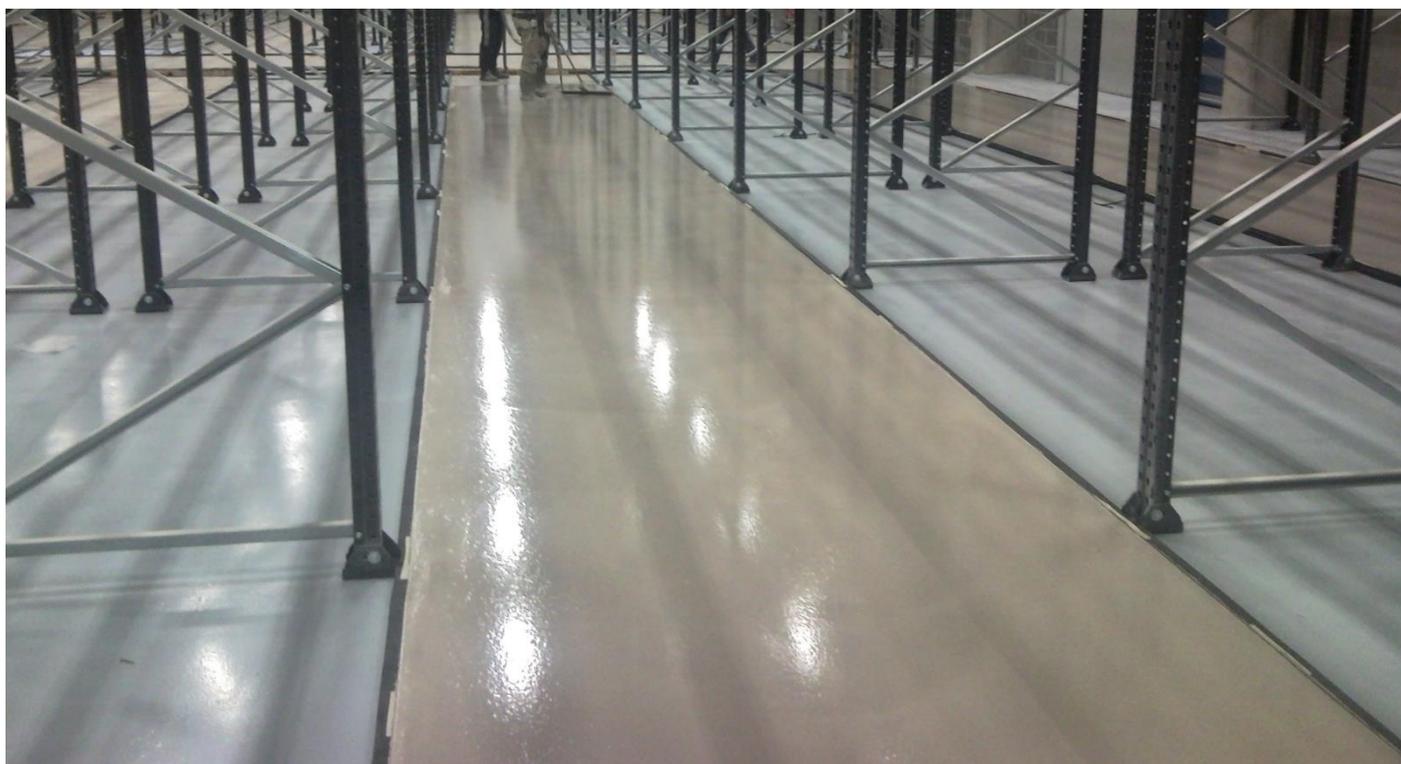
Ejemplo de sistemas terminado en industria con requerimiento de alta planimetría.
